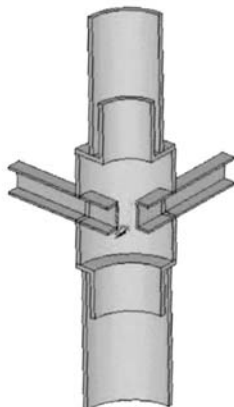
Вид узла сопряжения в строящемся здании и разработанный элемент узла сопряжения трубобетонной колонны с перекрытием
